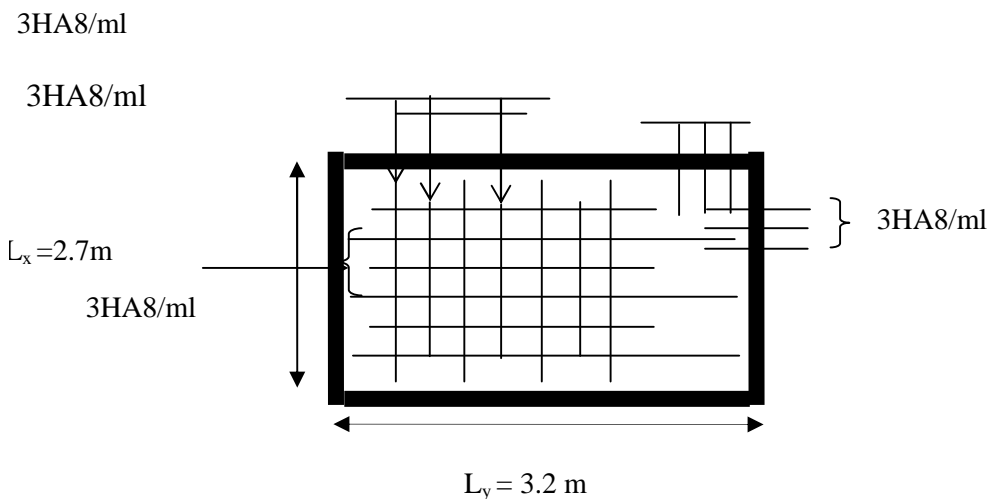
Schéma de ferrailage dans la dalle de l'ascenseur
